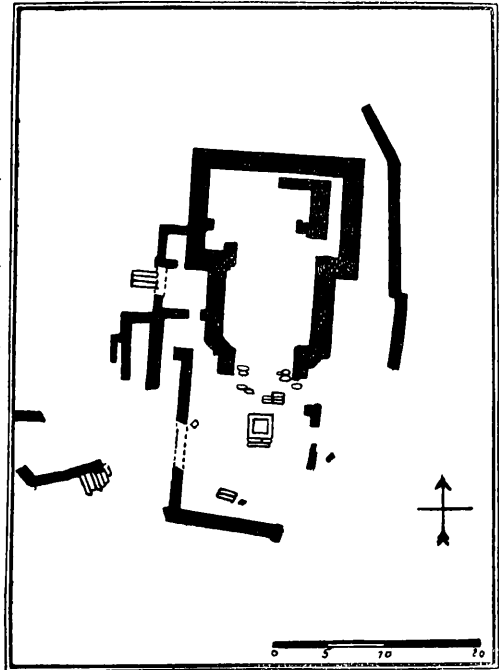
PLAN DU TEMPLE DE BA'AL.
